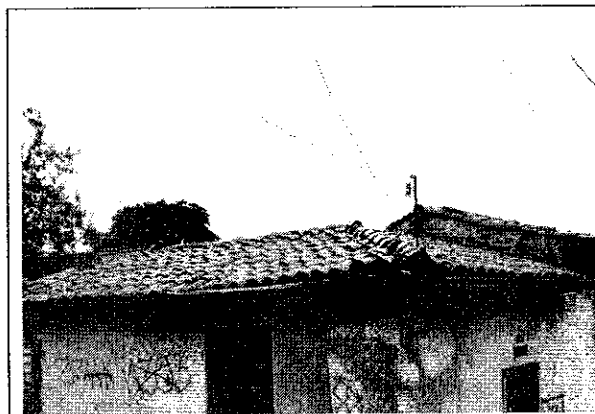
Vista general de la cubierta, donde se observa un buen estado de conservación.
